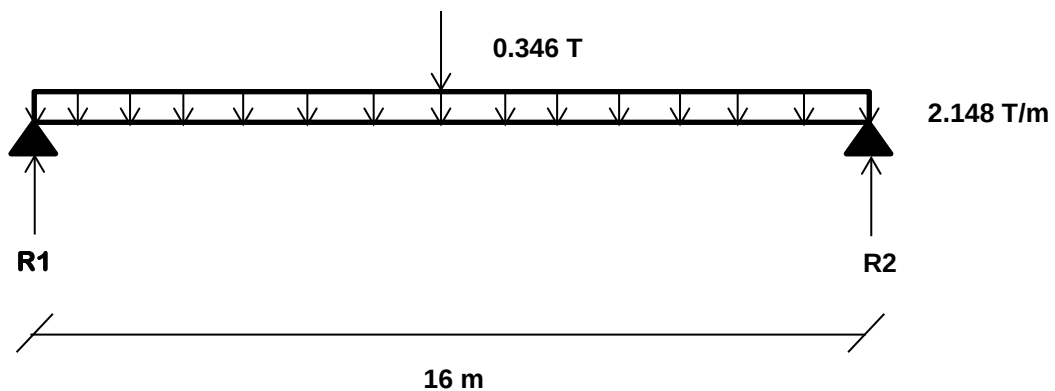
Esquema simplificado de la viga exterior longitudinal apoyada sobre los estribos,, con las carga muerta que actúa en ella.
